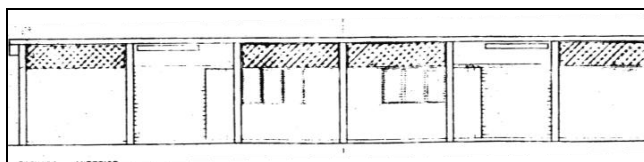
c. Vivienda SF-1. Fachada (1952)
